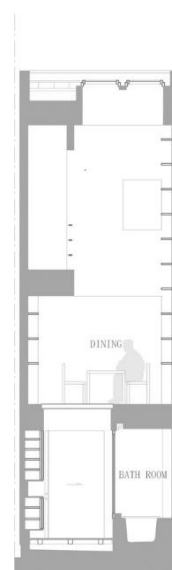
Corte longitudinal 2 (Archdaily, 2013)
